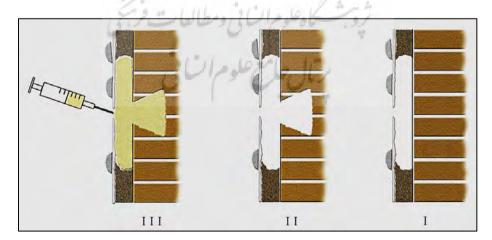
تثبيت پشت و روى لايهٔ بستر سقف گنبد بقعهٔ سيد ركن الدين Fig; 5: Stabilization of back and forth of fine coat in dome roof of Rokn al-Din mausoleum
